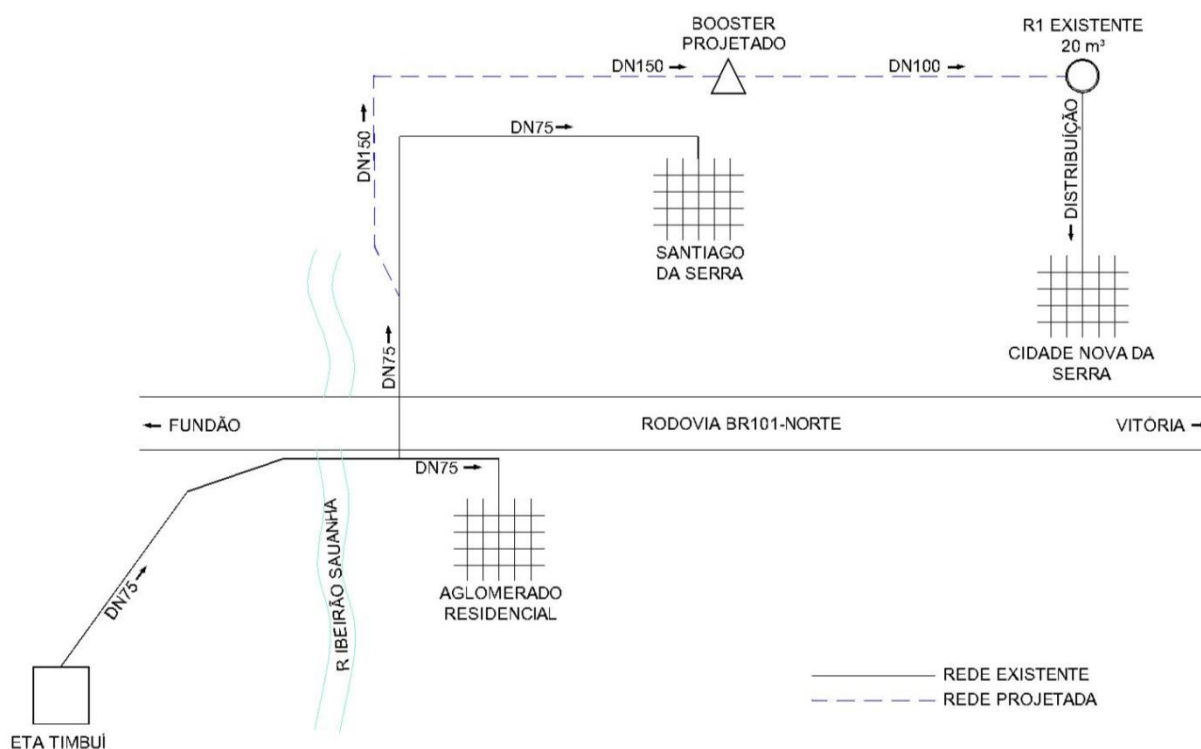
Esquema geral em planta da proposição do Cenário 1 - Emergencial.
